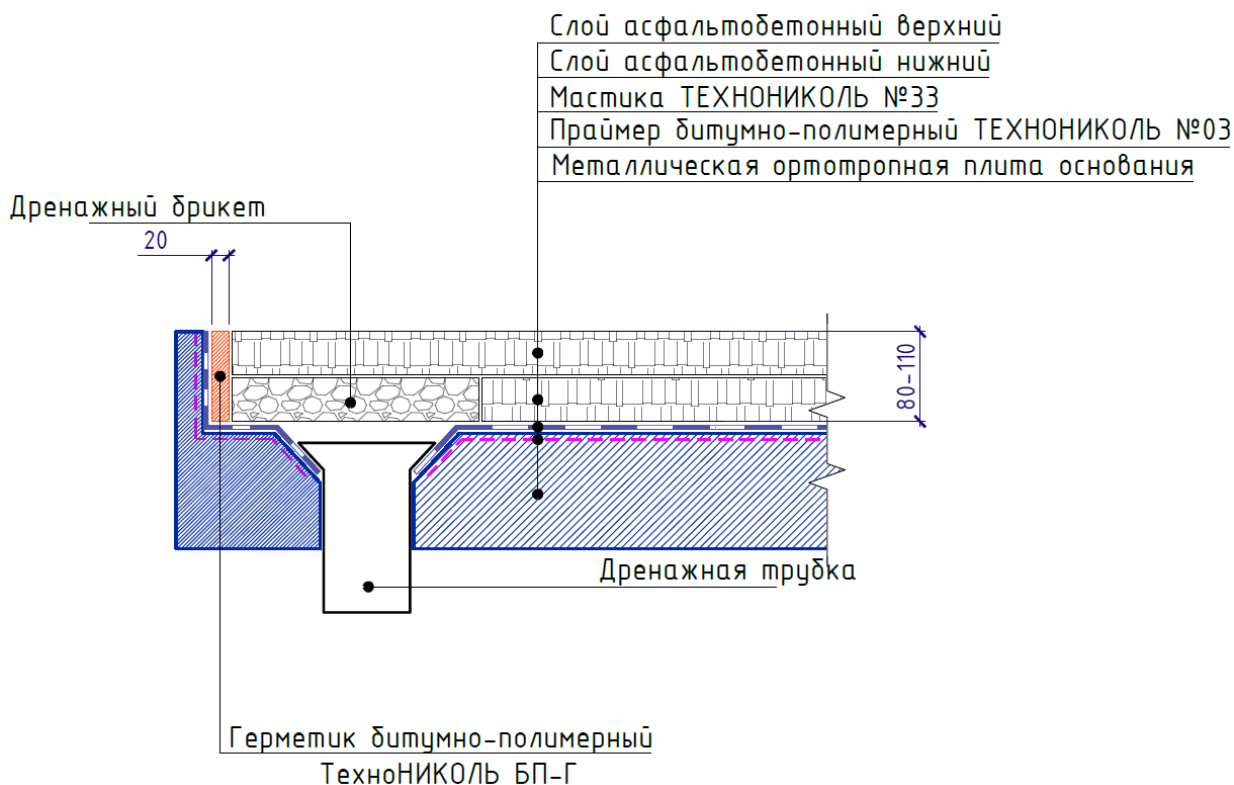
конструкция сопряжения гидроизоляции с дренажной трубкой и металлическим бортиком
